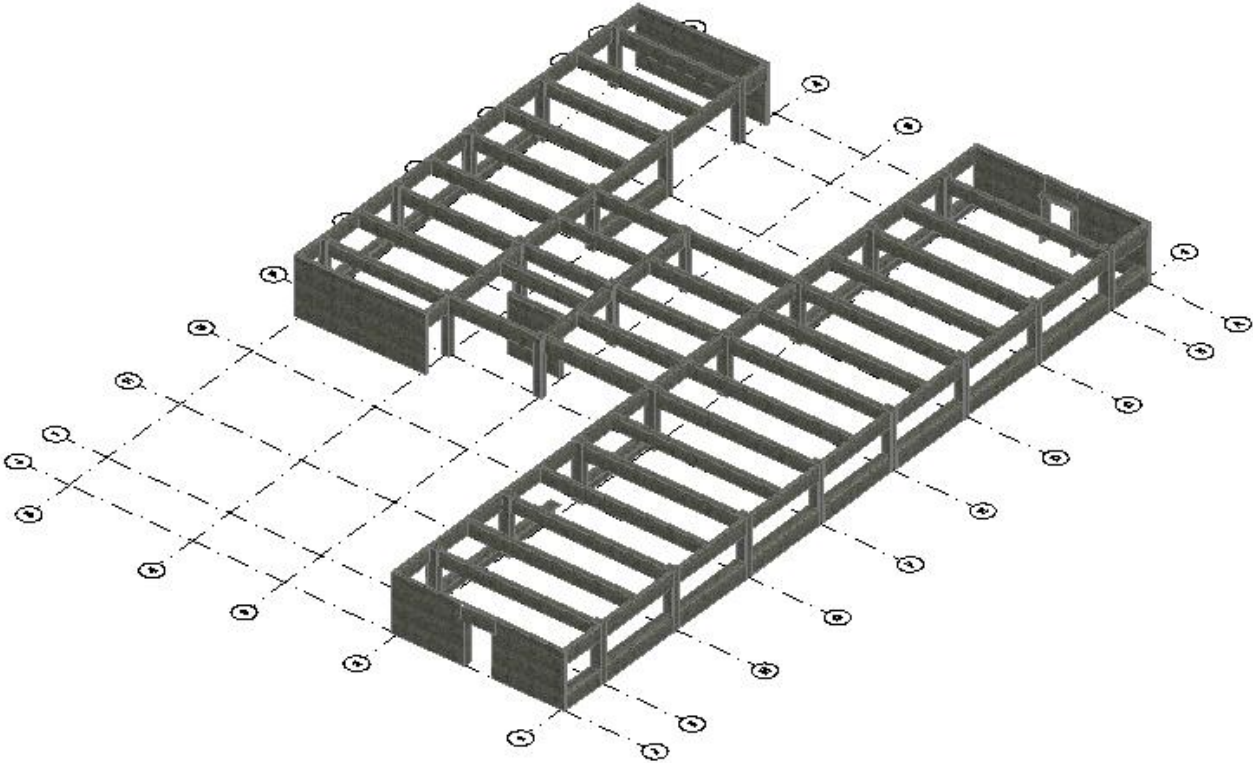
Vista en 3D, de la retícula estructural de la Planta Baja
